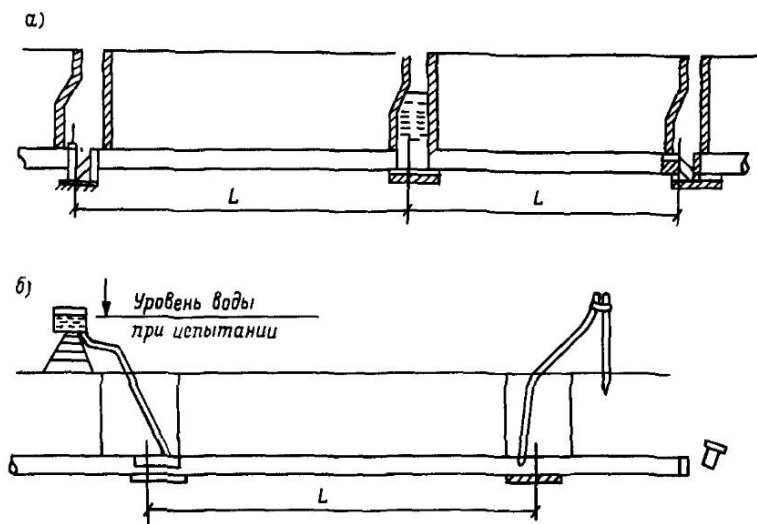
Гидравлическое испытание канализационных линий на утечку воды из трубопровода
